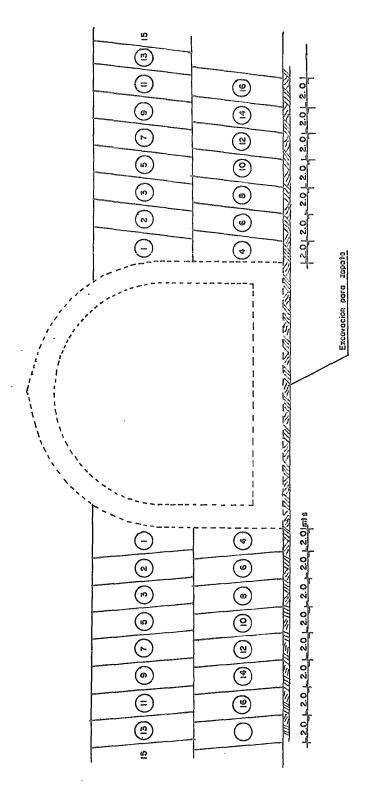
SECUENCIA DE EXCAVACION TUNEL DE ANDEN
